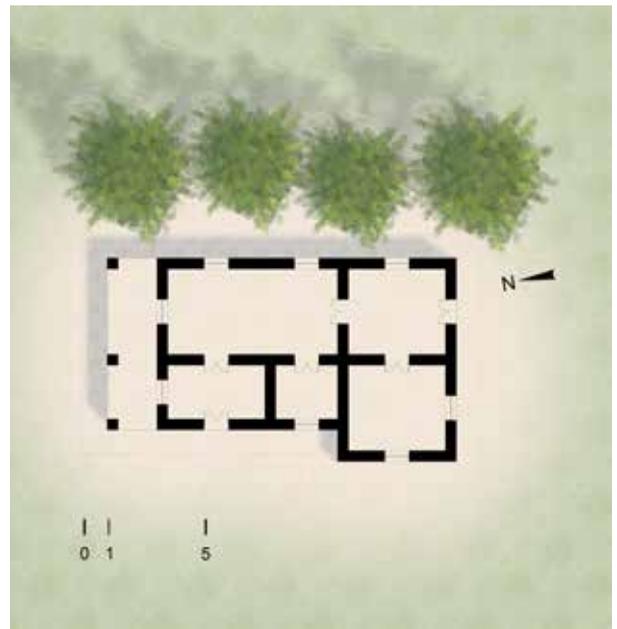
| Planta de la casa de los vigilantes, actualmente área de recepción. Ilustración: D. García.
